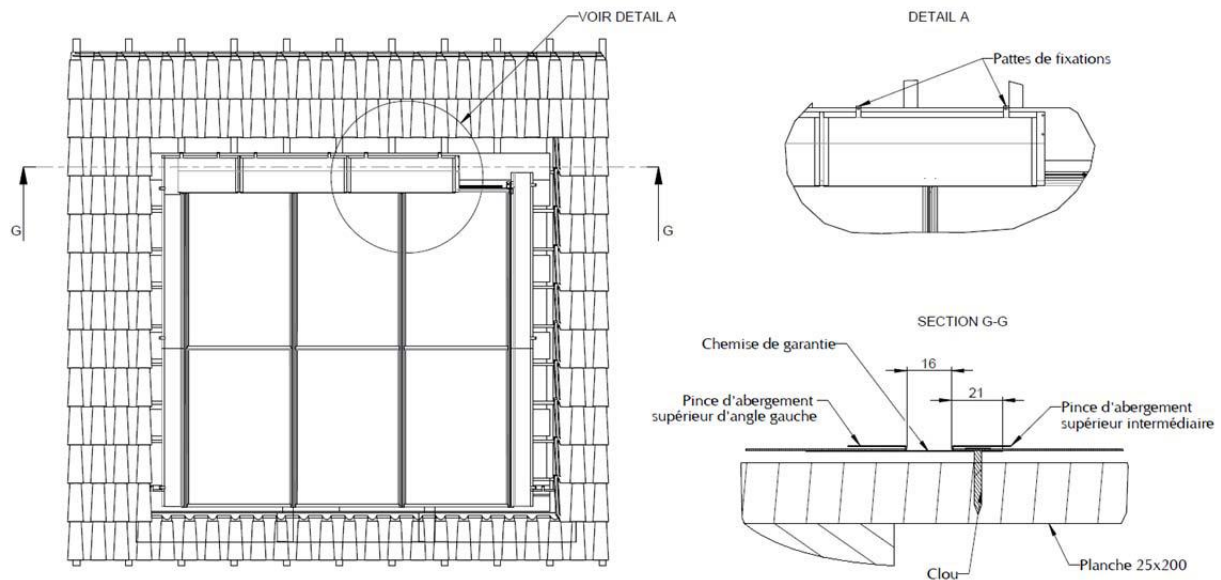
Pose des abergements supérieurs intermédiaires pour installation sur toiture tuile
